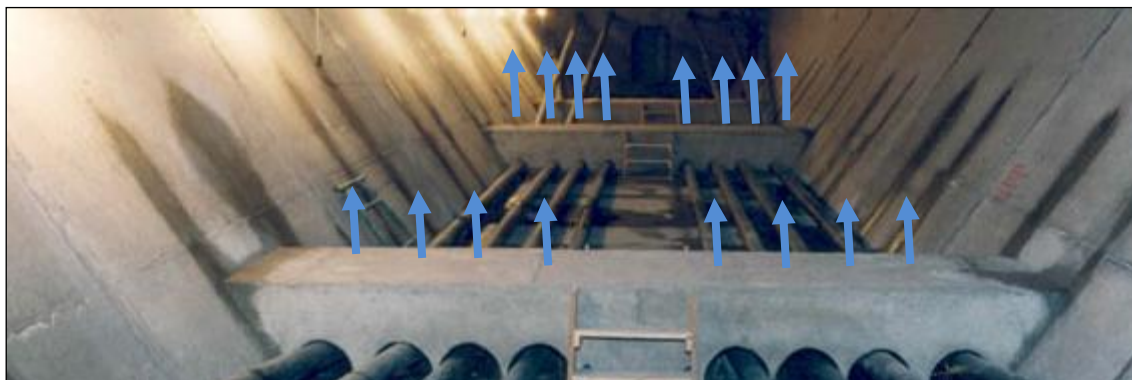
Interior d'una biga tipus caixó, amb pretensat exterior
